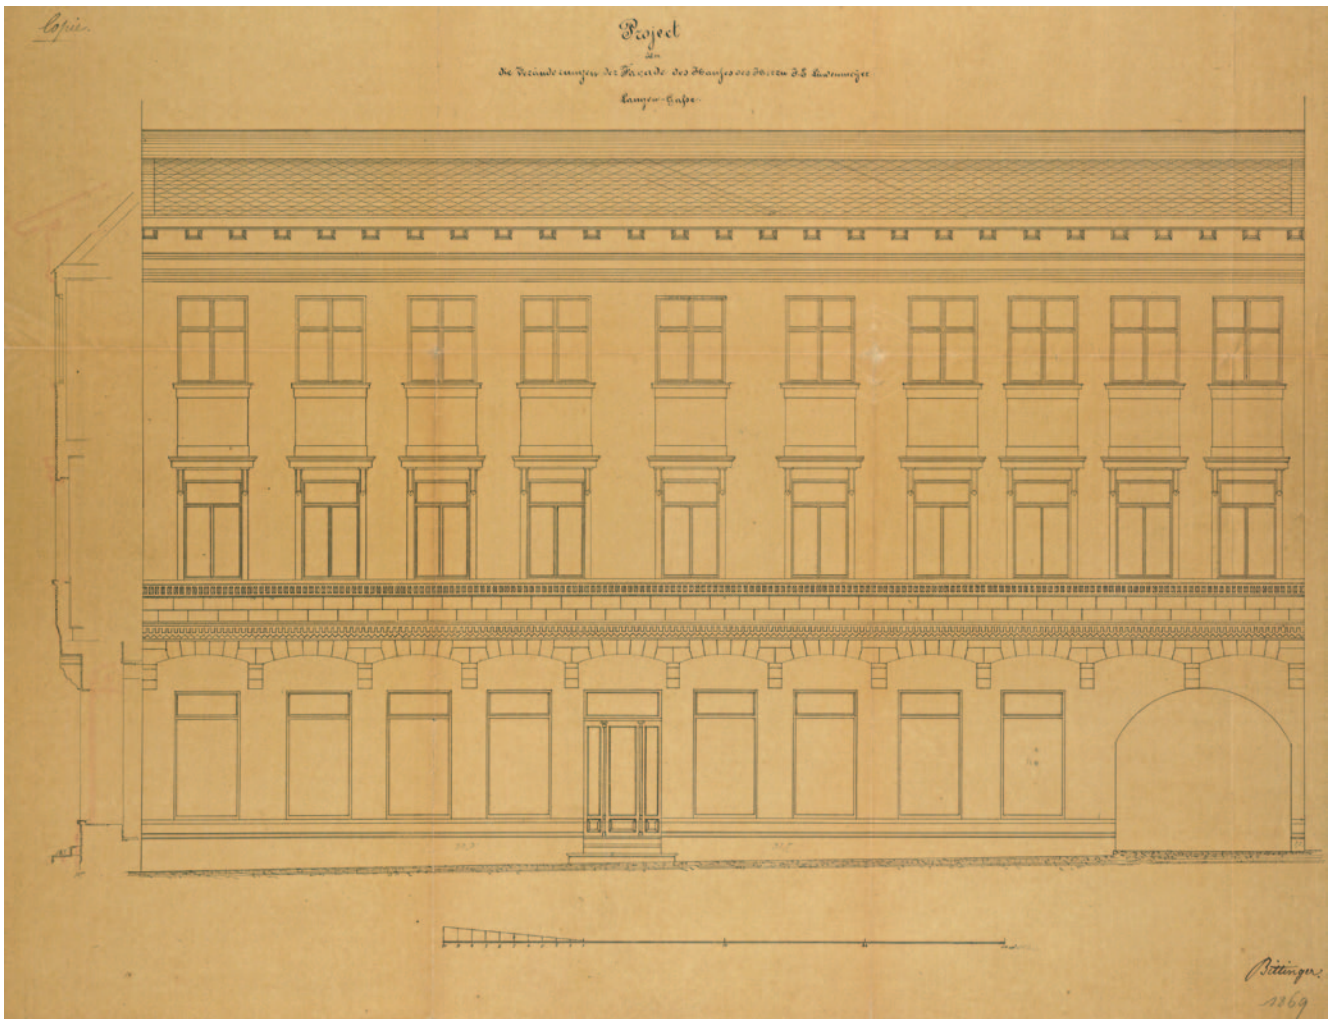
Gebäude Lange Straße 16 (A 261), Fassade zur Straße, Zustand vor dem Umbau, Baugesuch 1869.
